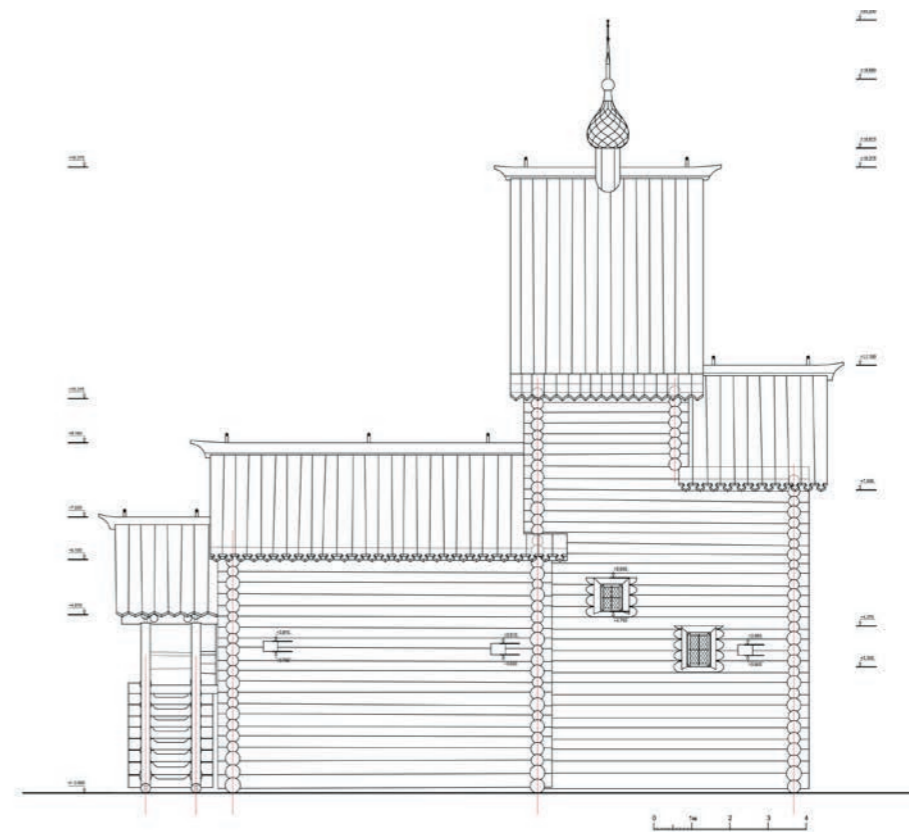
Южный фасад Троицкой церкви. Реконструкция. Чертеж
